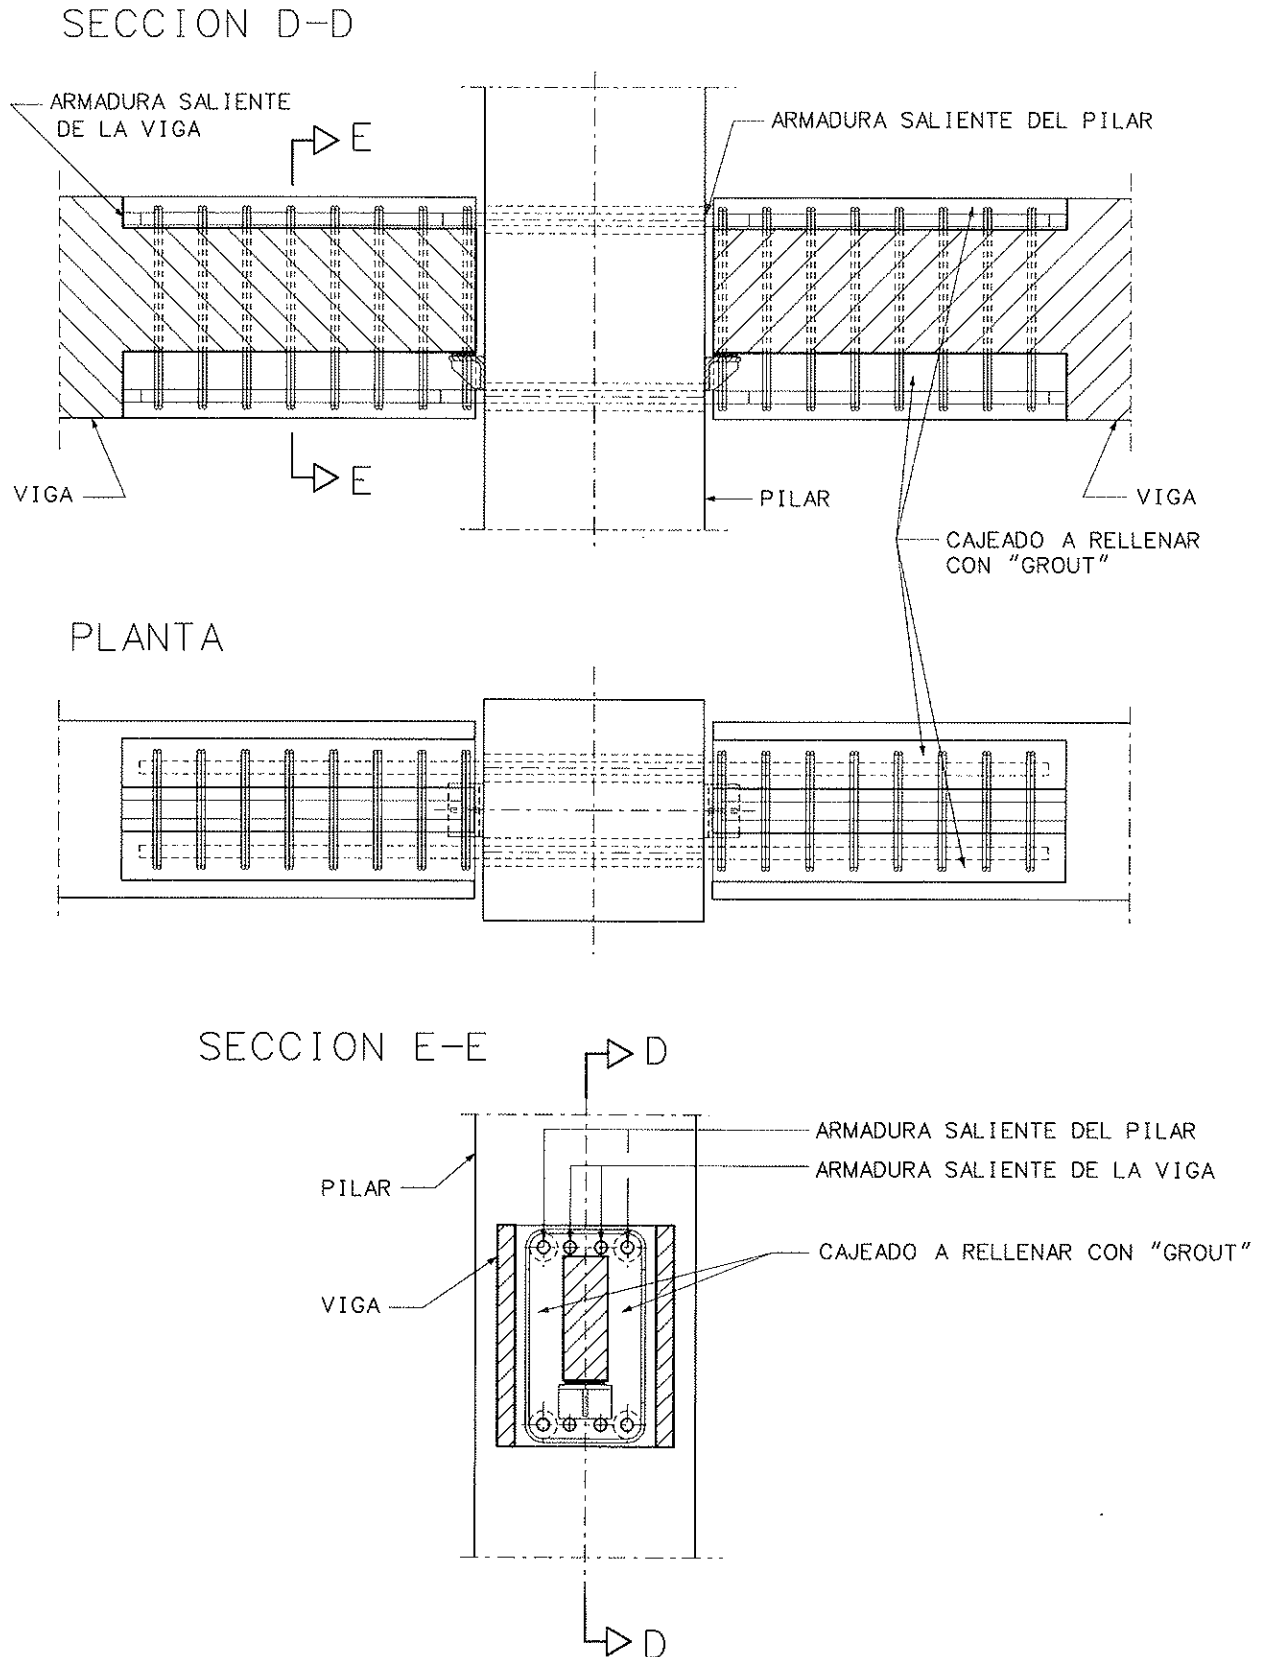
Nudo pilar-viga con armaduras horizontales pasantes.
